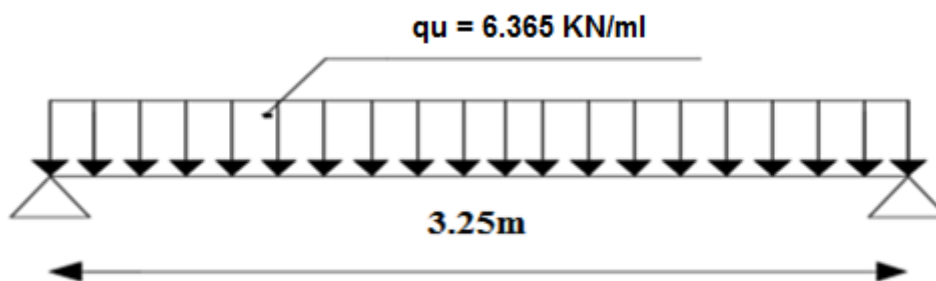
Schéma statique de calcul poutre chaînage à l'ELU.
